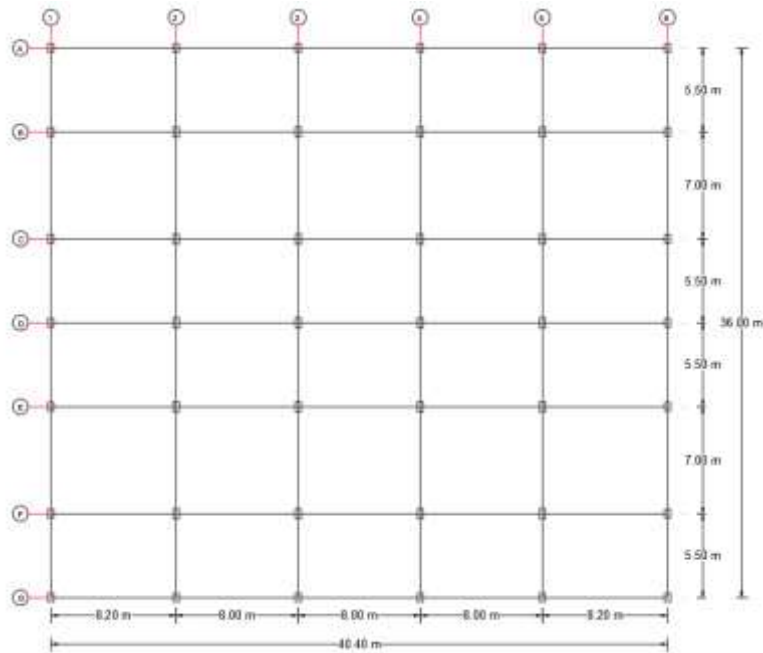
Vista en planta del ex parqueadero de la ULEAM y se indican los pórticos que se va a generar con CEINCI-LAB.
